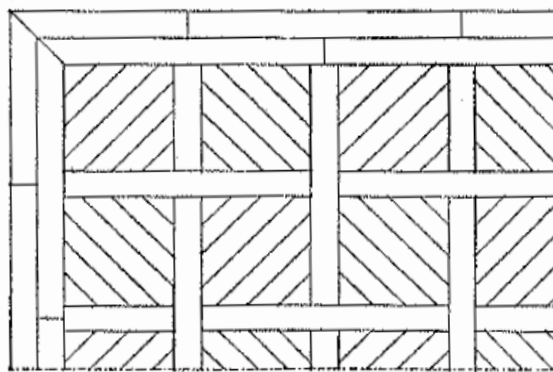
Configuração de um tecto apanelado e encabeirado [Costa, 1955].
